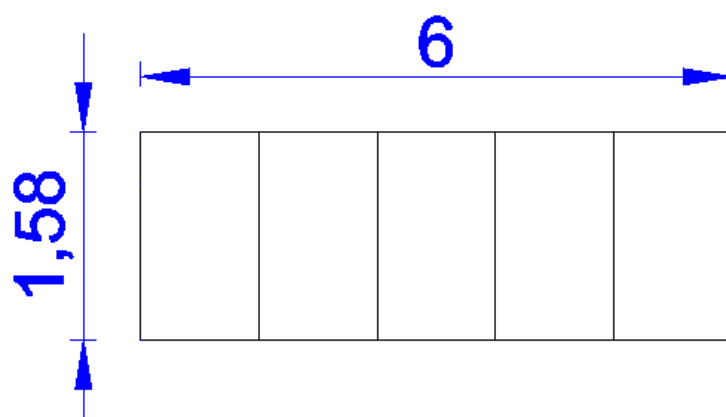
Vista en planta d'un bloc de 5 captadors [m].
